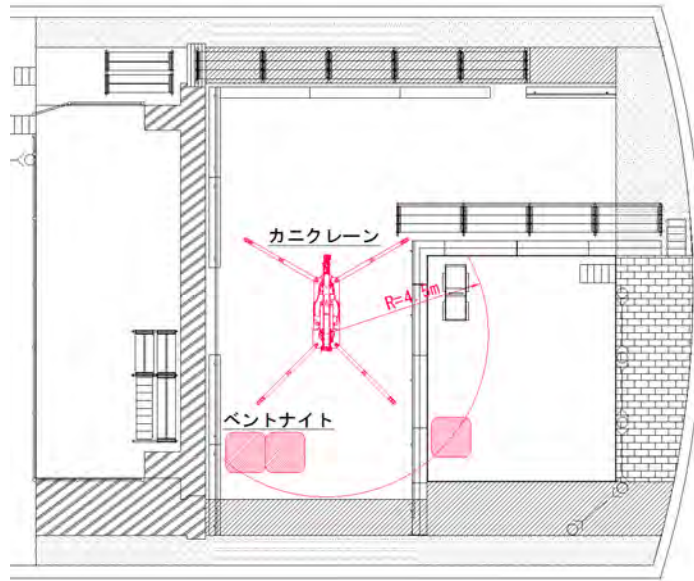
ベントナイト（フレコン）供給状況平面図
